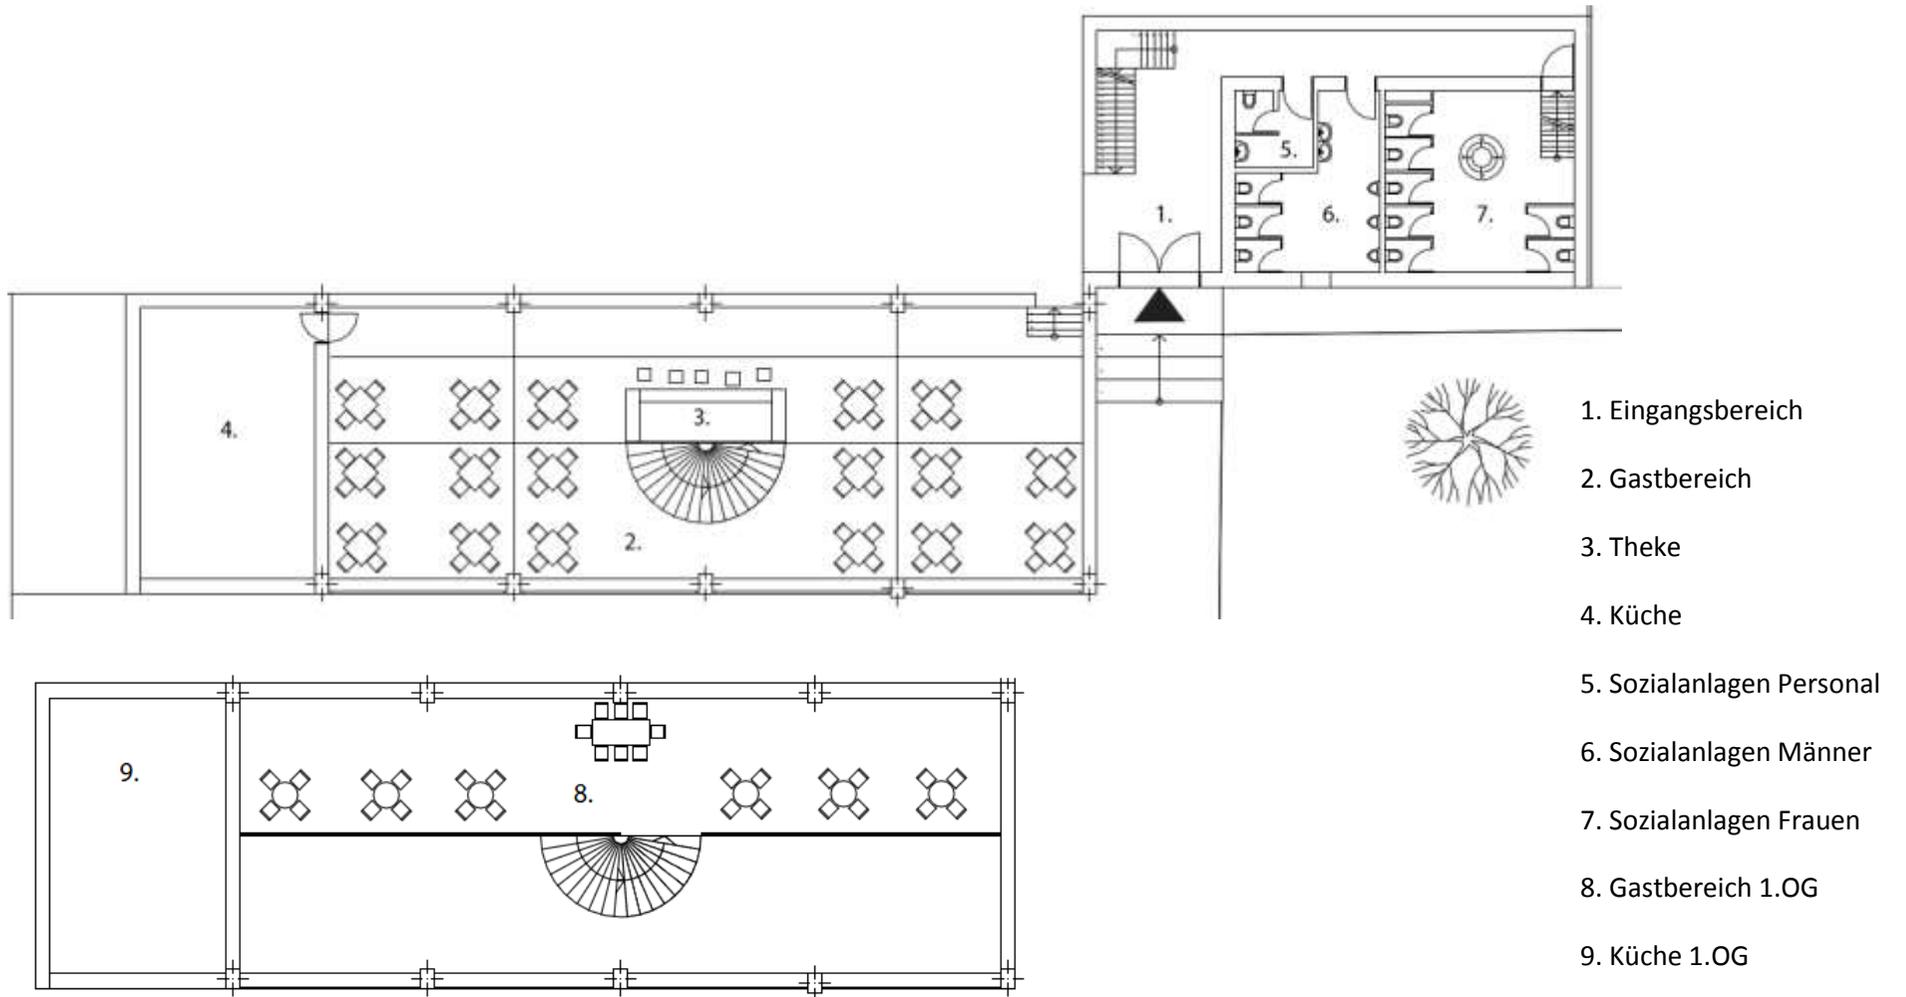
Grundriss Restaurant und oberer Grundriss des Restaurants
